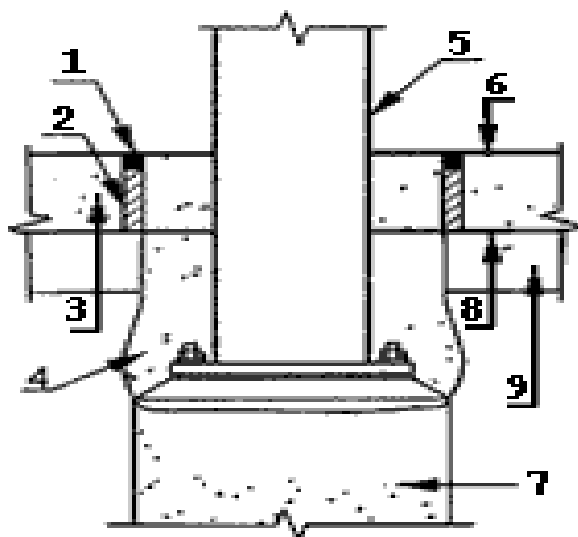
Конструкция изолирующего шва между колонной и плитой пола
